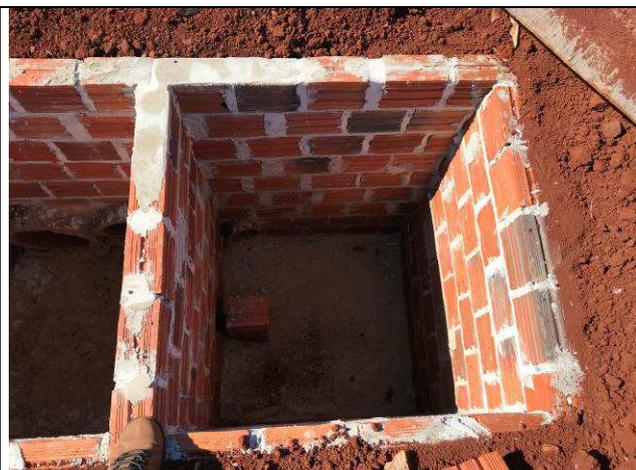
C: Tubos de PVC em caixa de passagem - esgoto.
